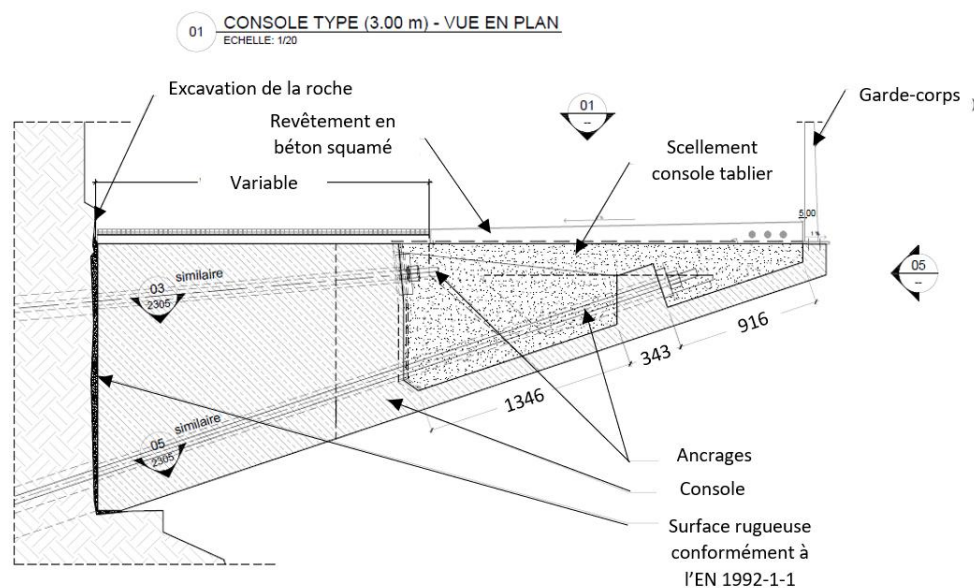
Tablier – Coupe transversale en rive (au droit d'une console)
